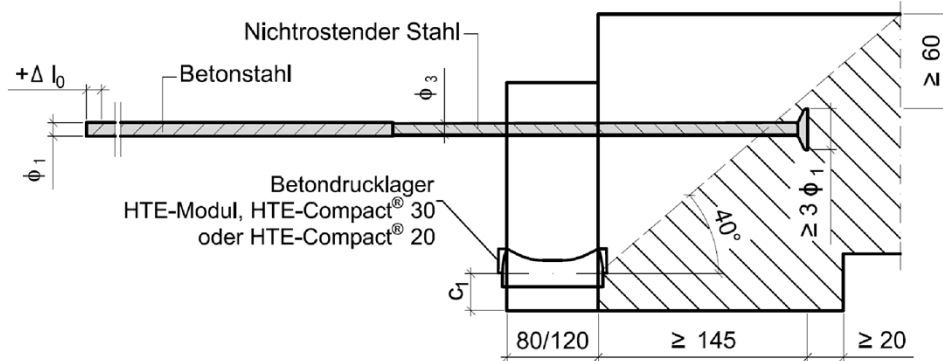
Zugstab für Schöck Isokorb® Typ K-U und Typ K-U-F mit Durchmesserkombination und Lage des Ankerkopfs
